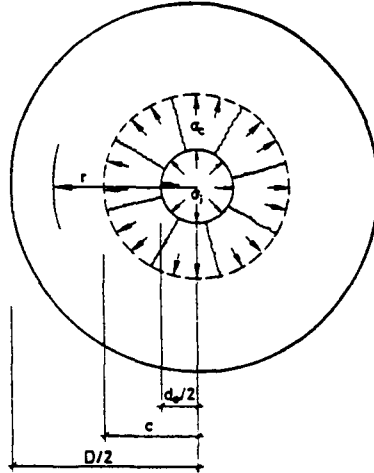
Betonzylinder mit innerer gerissener Zone nach Tefers [7]
